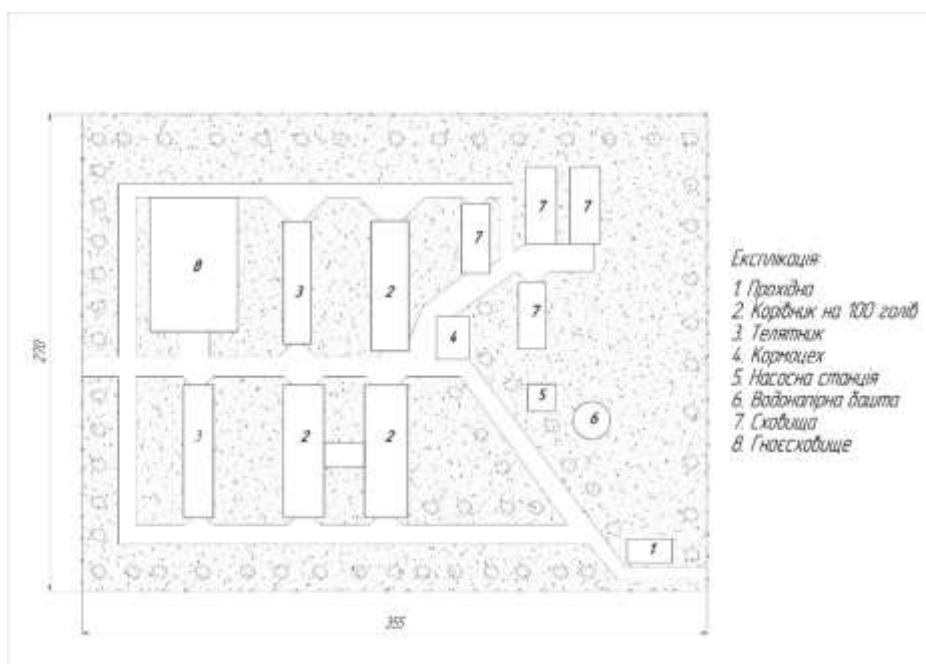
Схема генерального плану молочно-товарної ферми:
